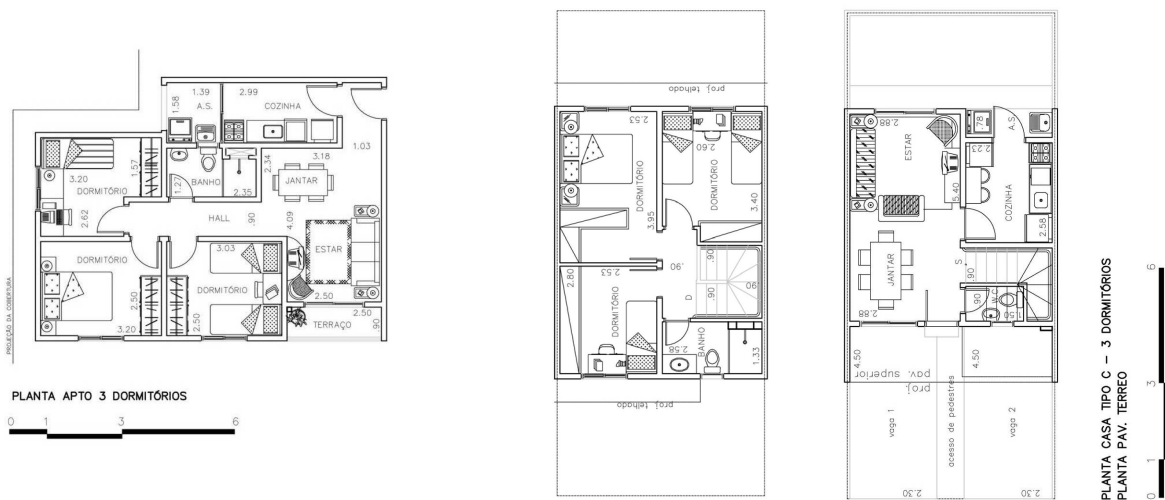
Plantas tipo de apartamento e sobrado do projeto Reserva Ibatyba (M-01).
